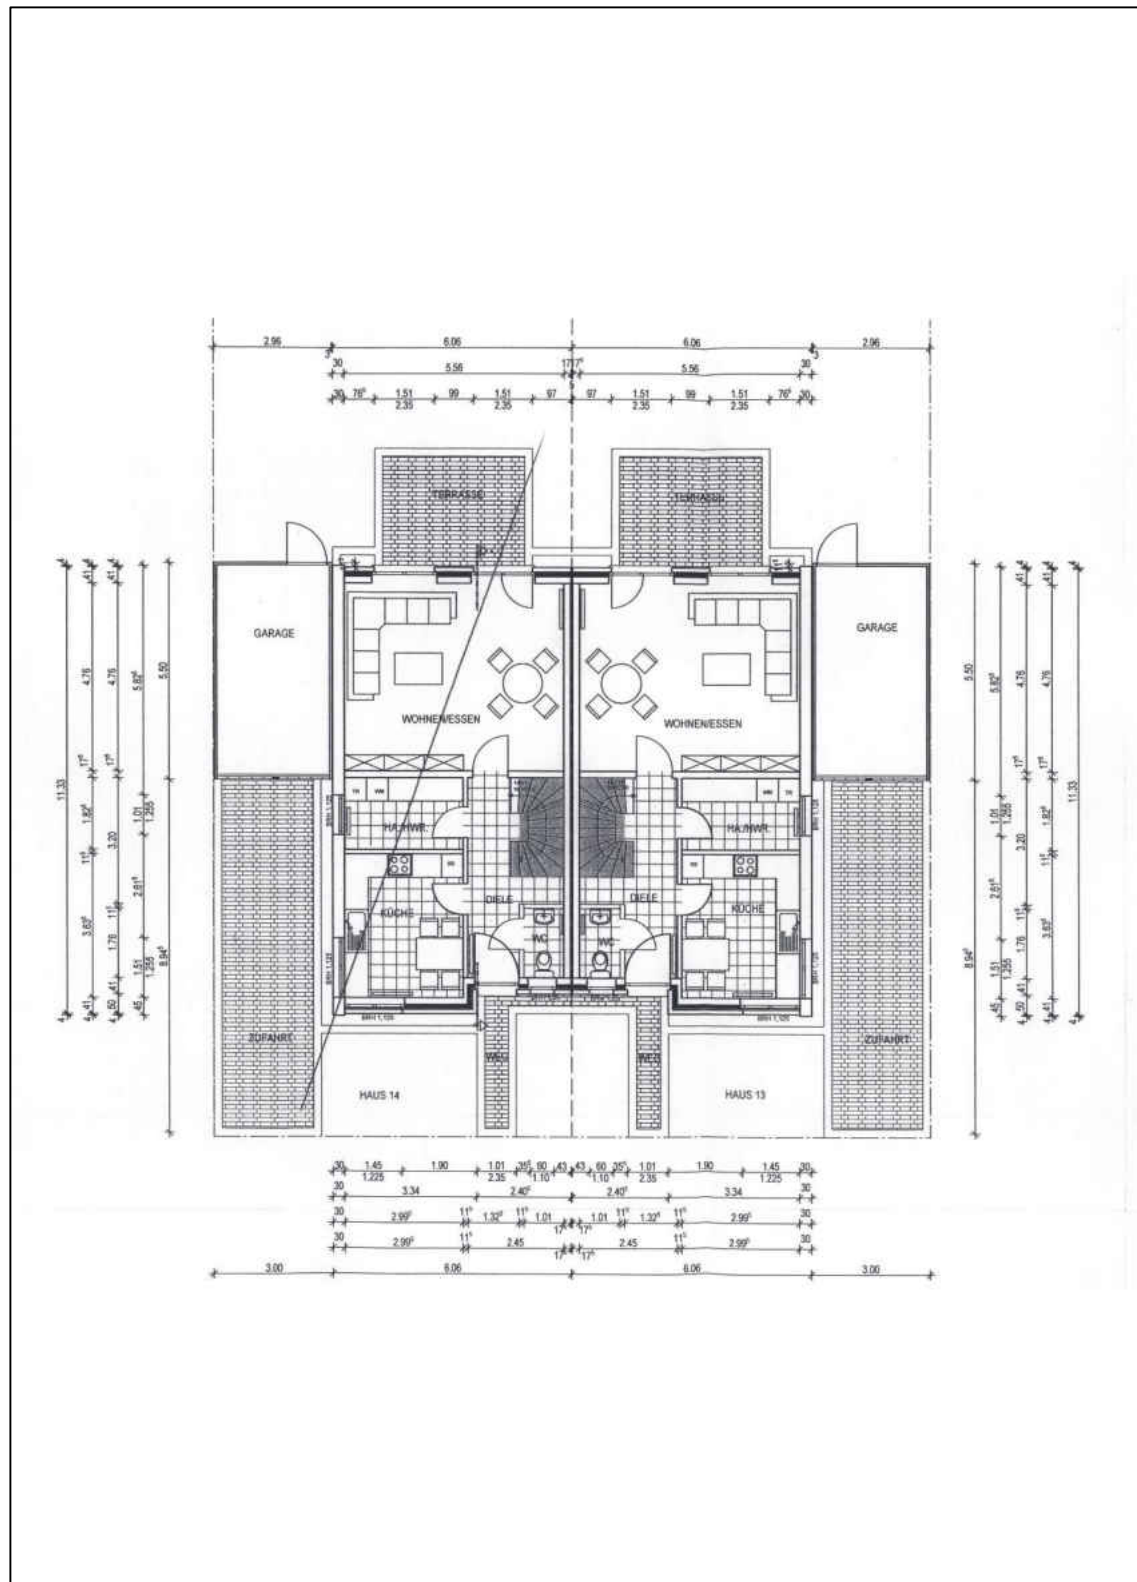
Grundriss vom Erdgeschoss
